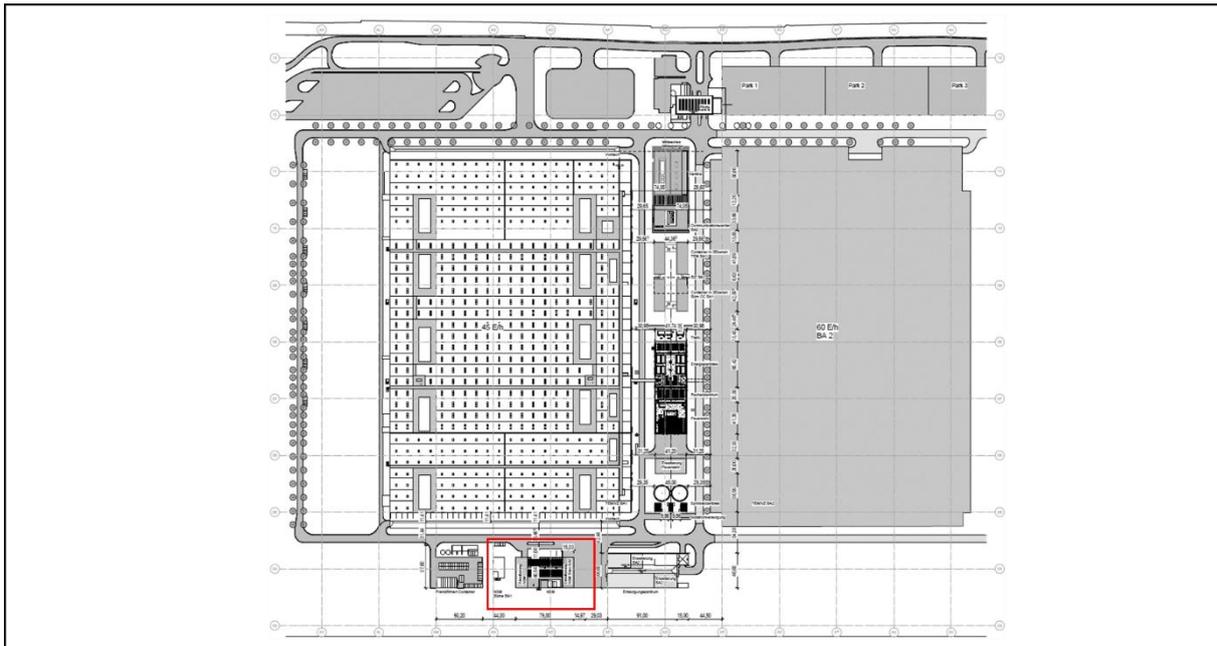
NSM-Lager - Lageplan Dachaufsicht.
